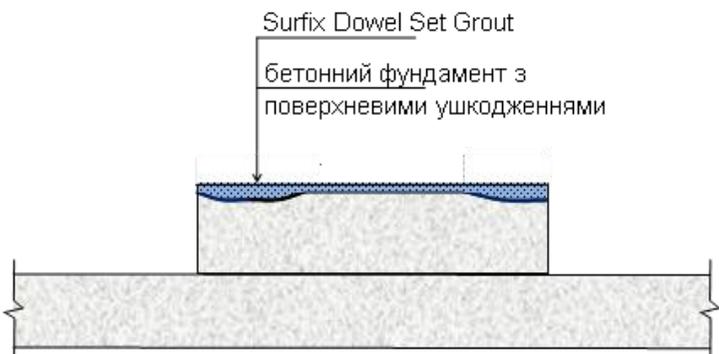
Стандартна схема відновлення бетонного фундаменту з поверхневими ушкодженнями під стаціонарне технологічне устаткування
